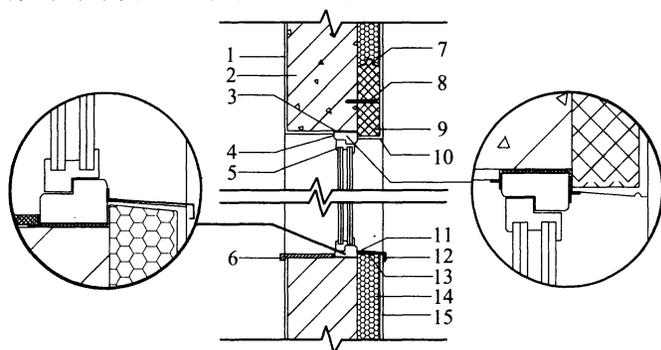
外墙粘贴系统门(窗)口保温防火构造示意
